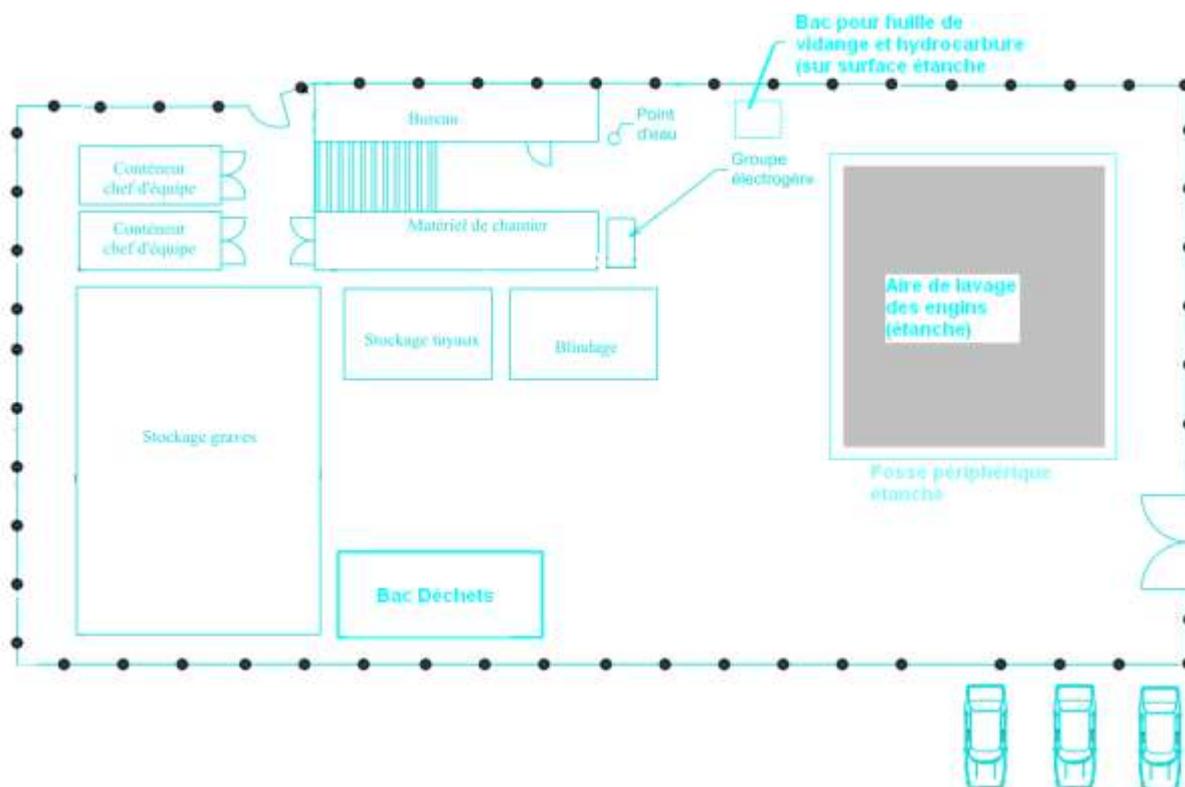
Plan d'installation de chantier et principe de collecte de seaux pluviales de l'aire de lavage
